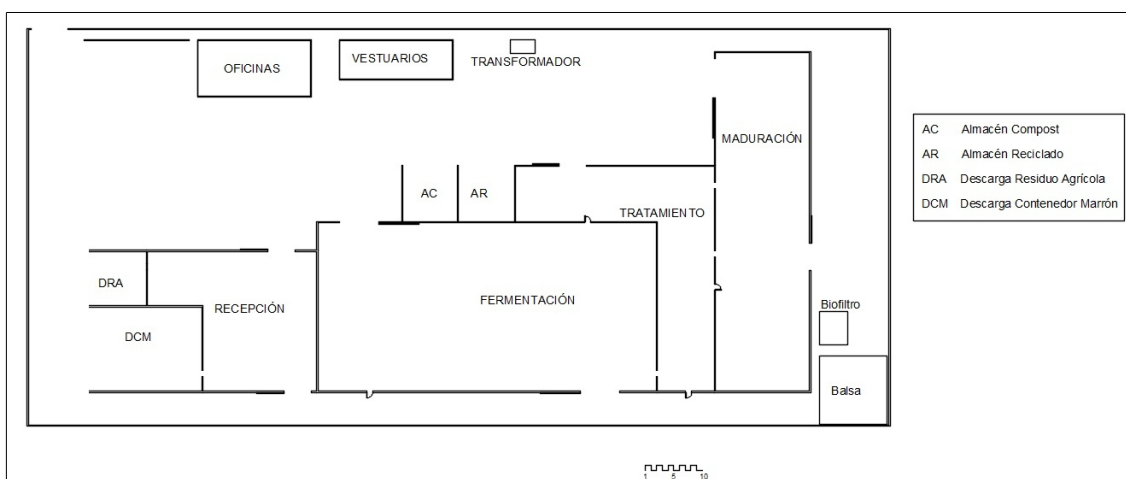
Plano de la distribución de espacios en la planta. Fuente propia.
